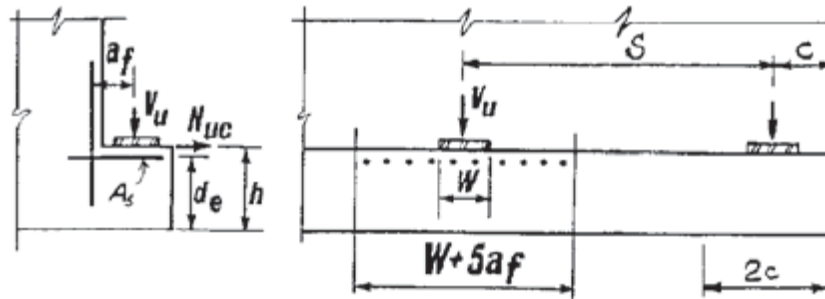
Diseño para flexión y fuerza horizontal de Vigas Repisa
